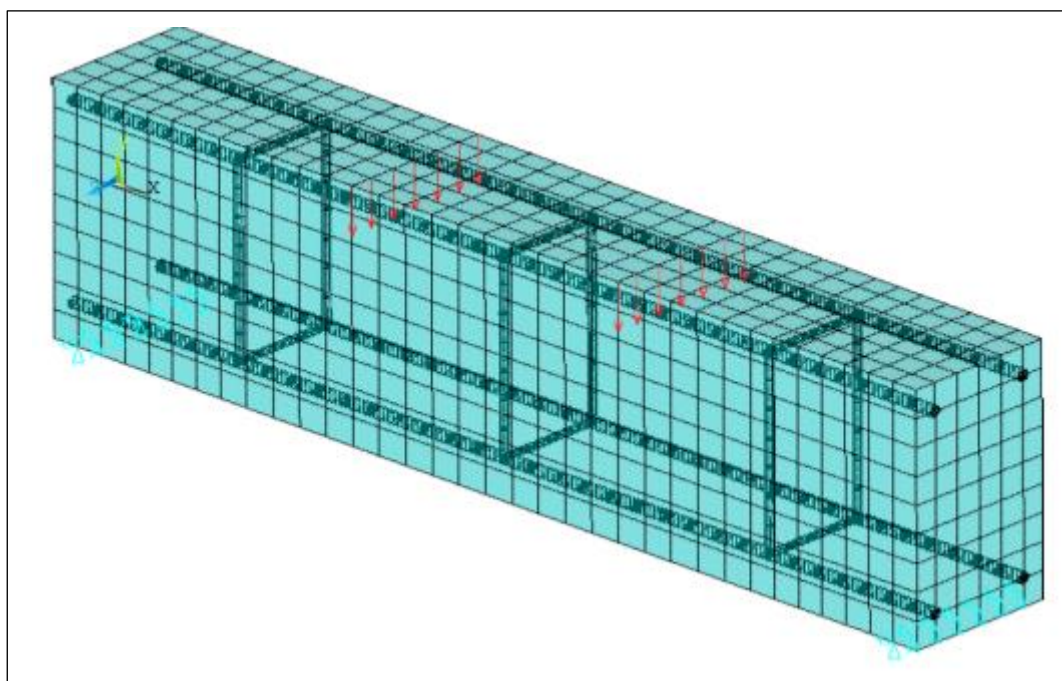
Discretização do modelo da viga de concreto reforçado como armação.
